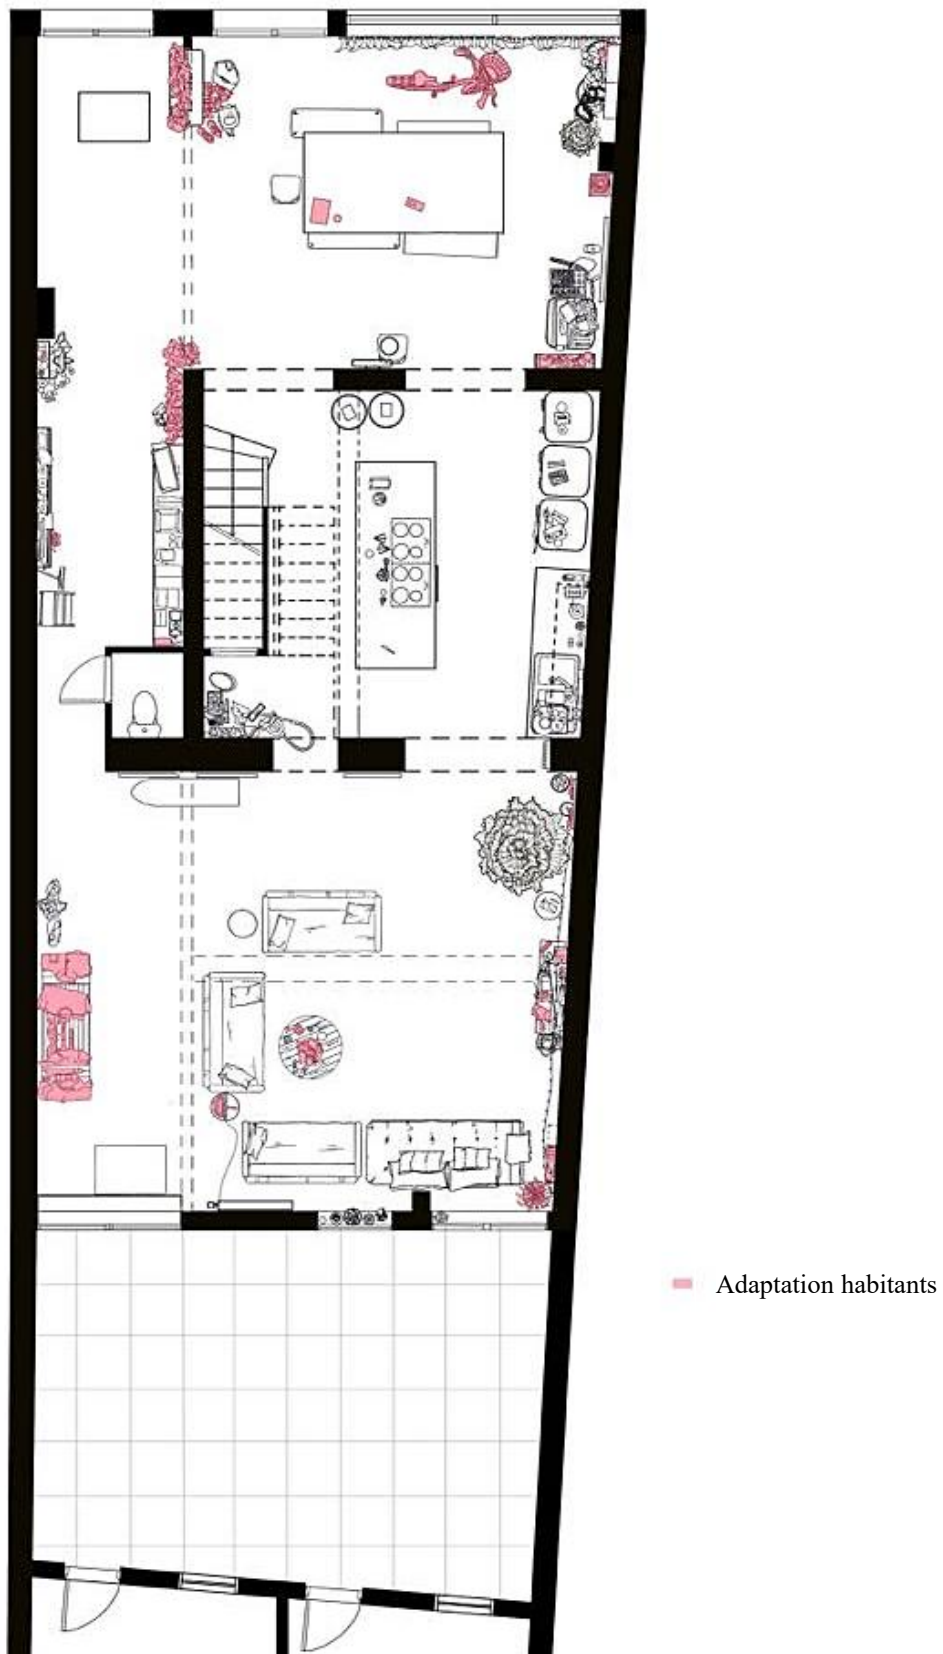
Relevé – plan du rdc de la maison Hors-château sur le site Ikoab
